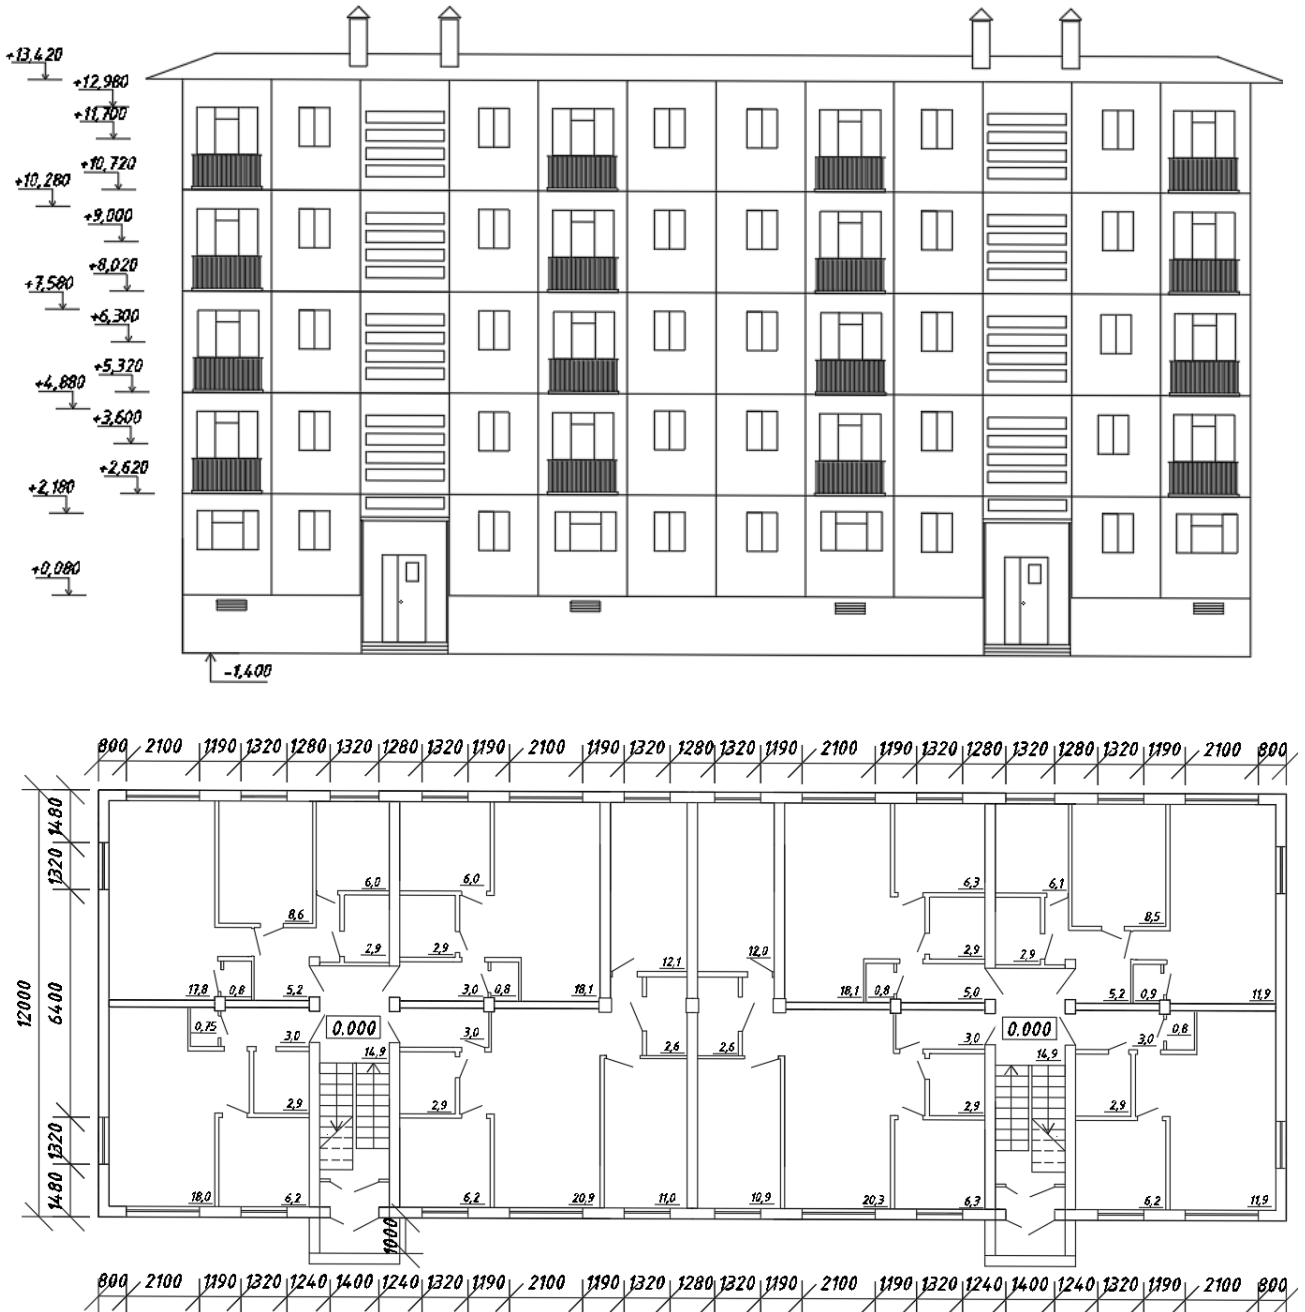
Фасад жилого дома и план типового этажа
